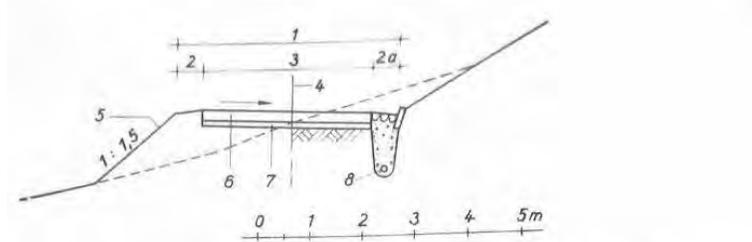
Sección transversal de un camino de una vía que conduce al área cultivada, en terreno ondulado y montañoso, con terreno de cimentación sensible a las heladas
